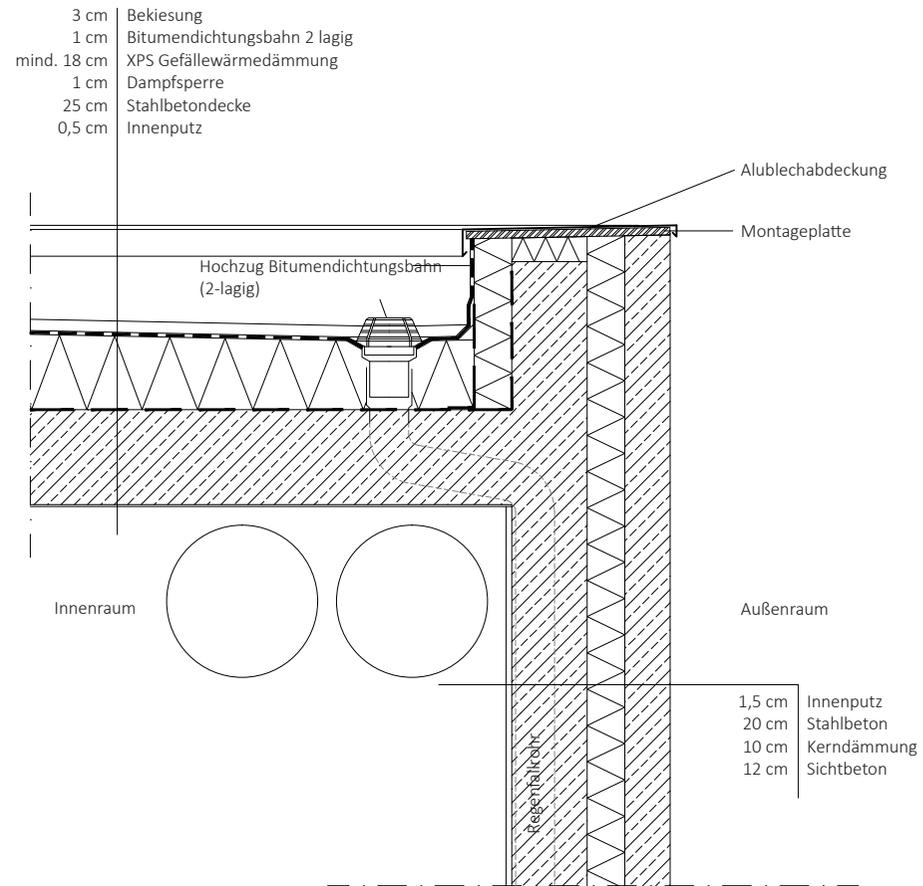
Dach, auskragende Kuben - Horizontalschnitt
